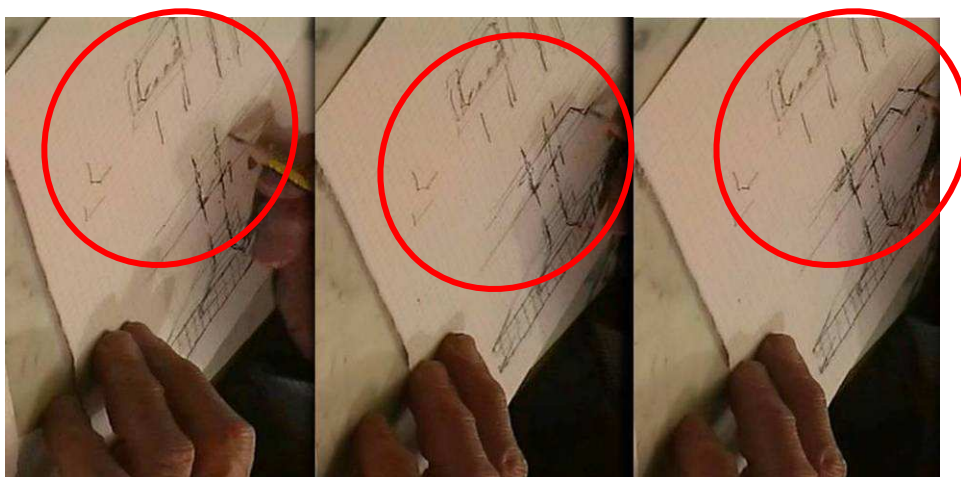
Detalle del doblado de armaduras en el nudo entre viga y pilar (Estellés, 2010).
